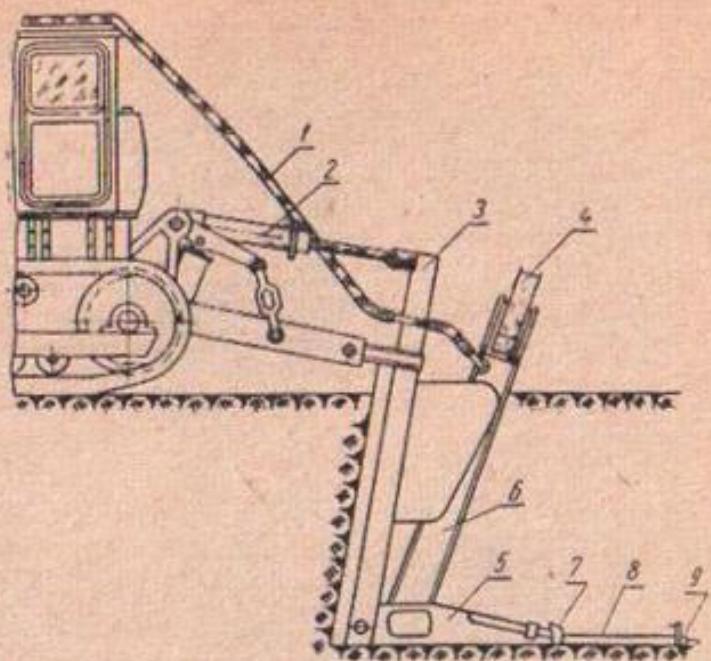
Конструктивная схема дреноукладчика ДПН-1,8 с рабочим органом для формирования и укладки труб из упругой ленты:
